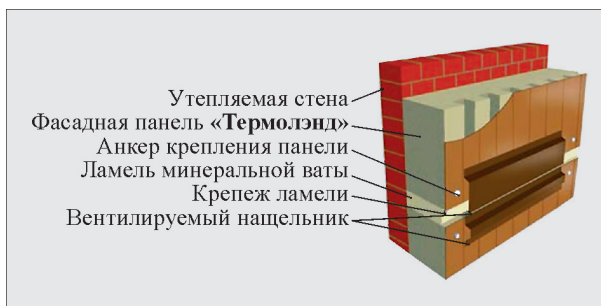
Теплоизоляционная фасадная система с вентиляруемыми каналами.
